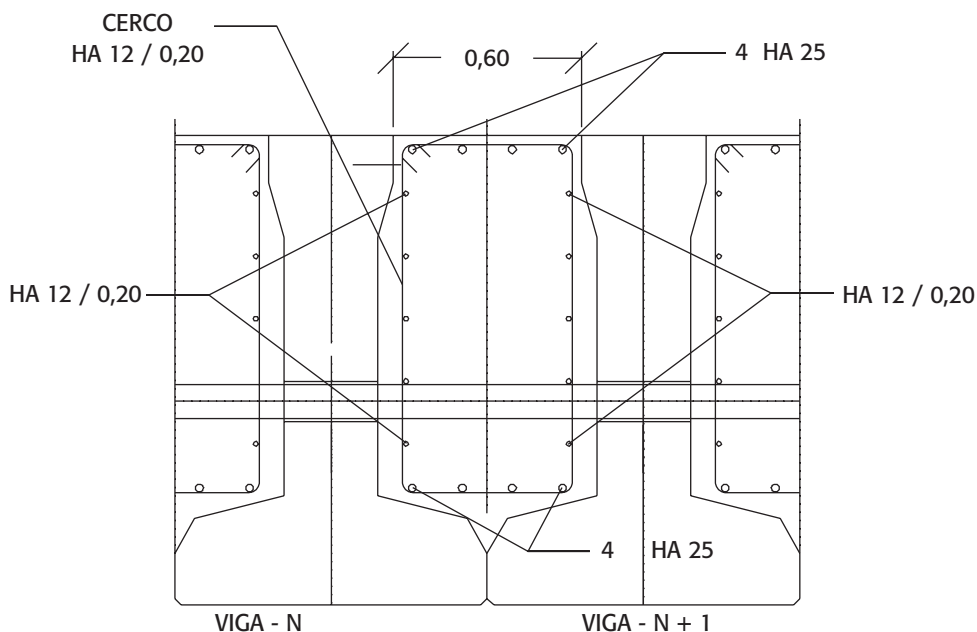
Armadura entre las vigas, sección conjunta típica de canto 1,5 m (S2)
